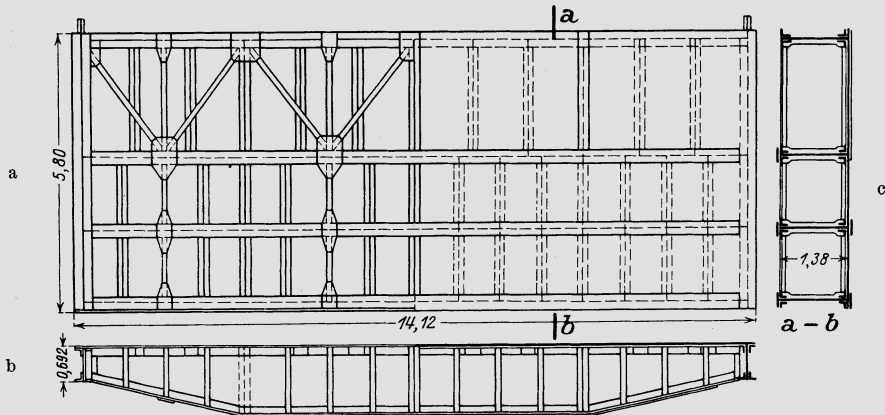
a bis c. Stoney-Schütz im Gatundamm. Maßstab 1 : 160.
